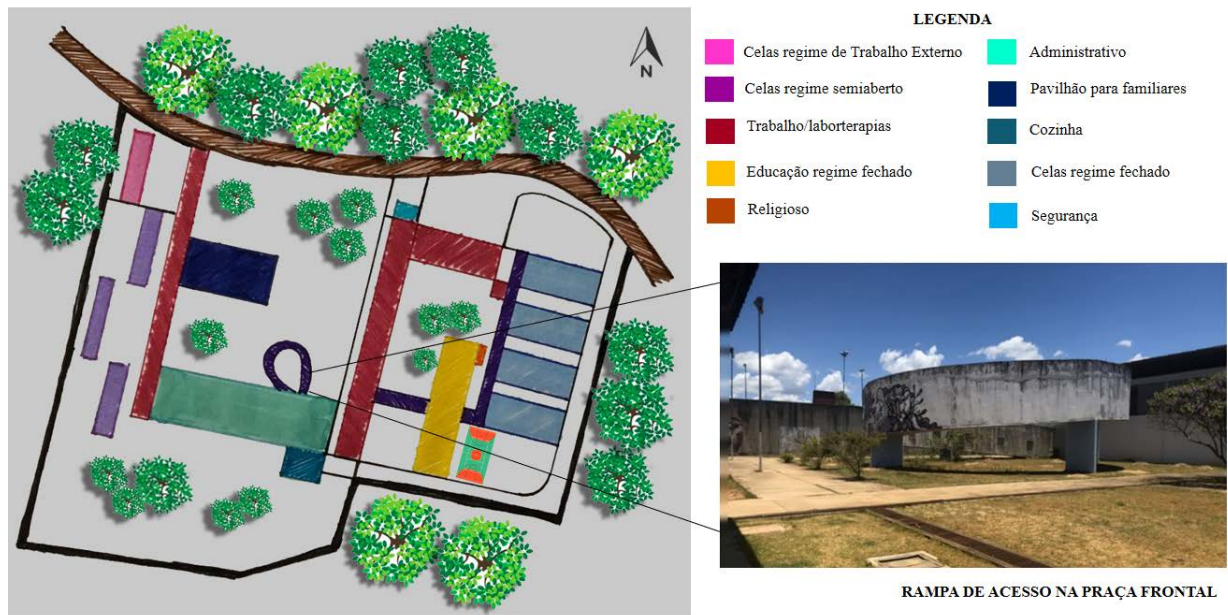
Croqui esquemático dos setores da unidade APAC Santa Luzia.
